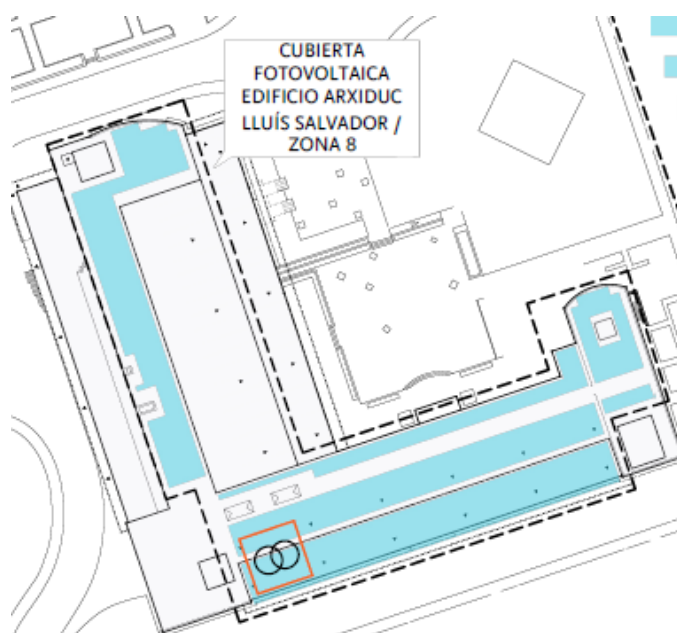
Disposición de las placas fotovoltaicas en la cubierta del edificio Arxiduc Lluís Salvador
